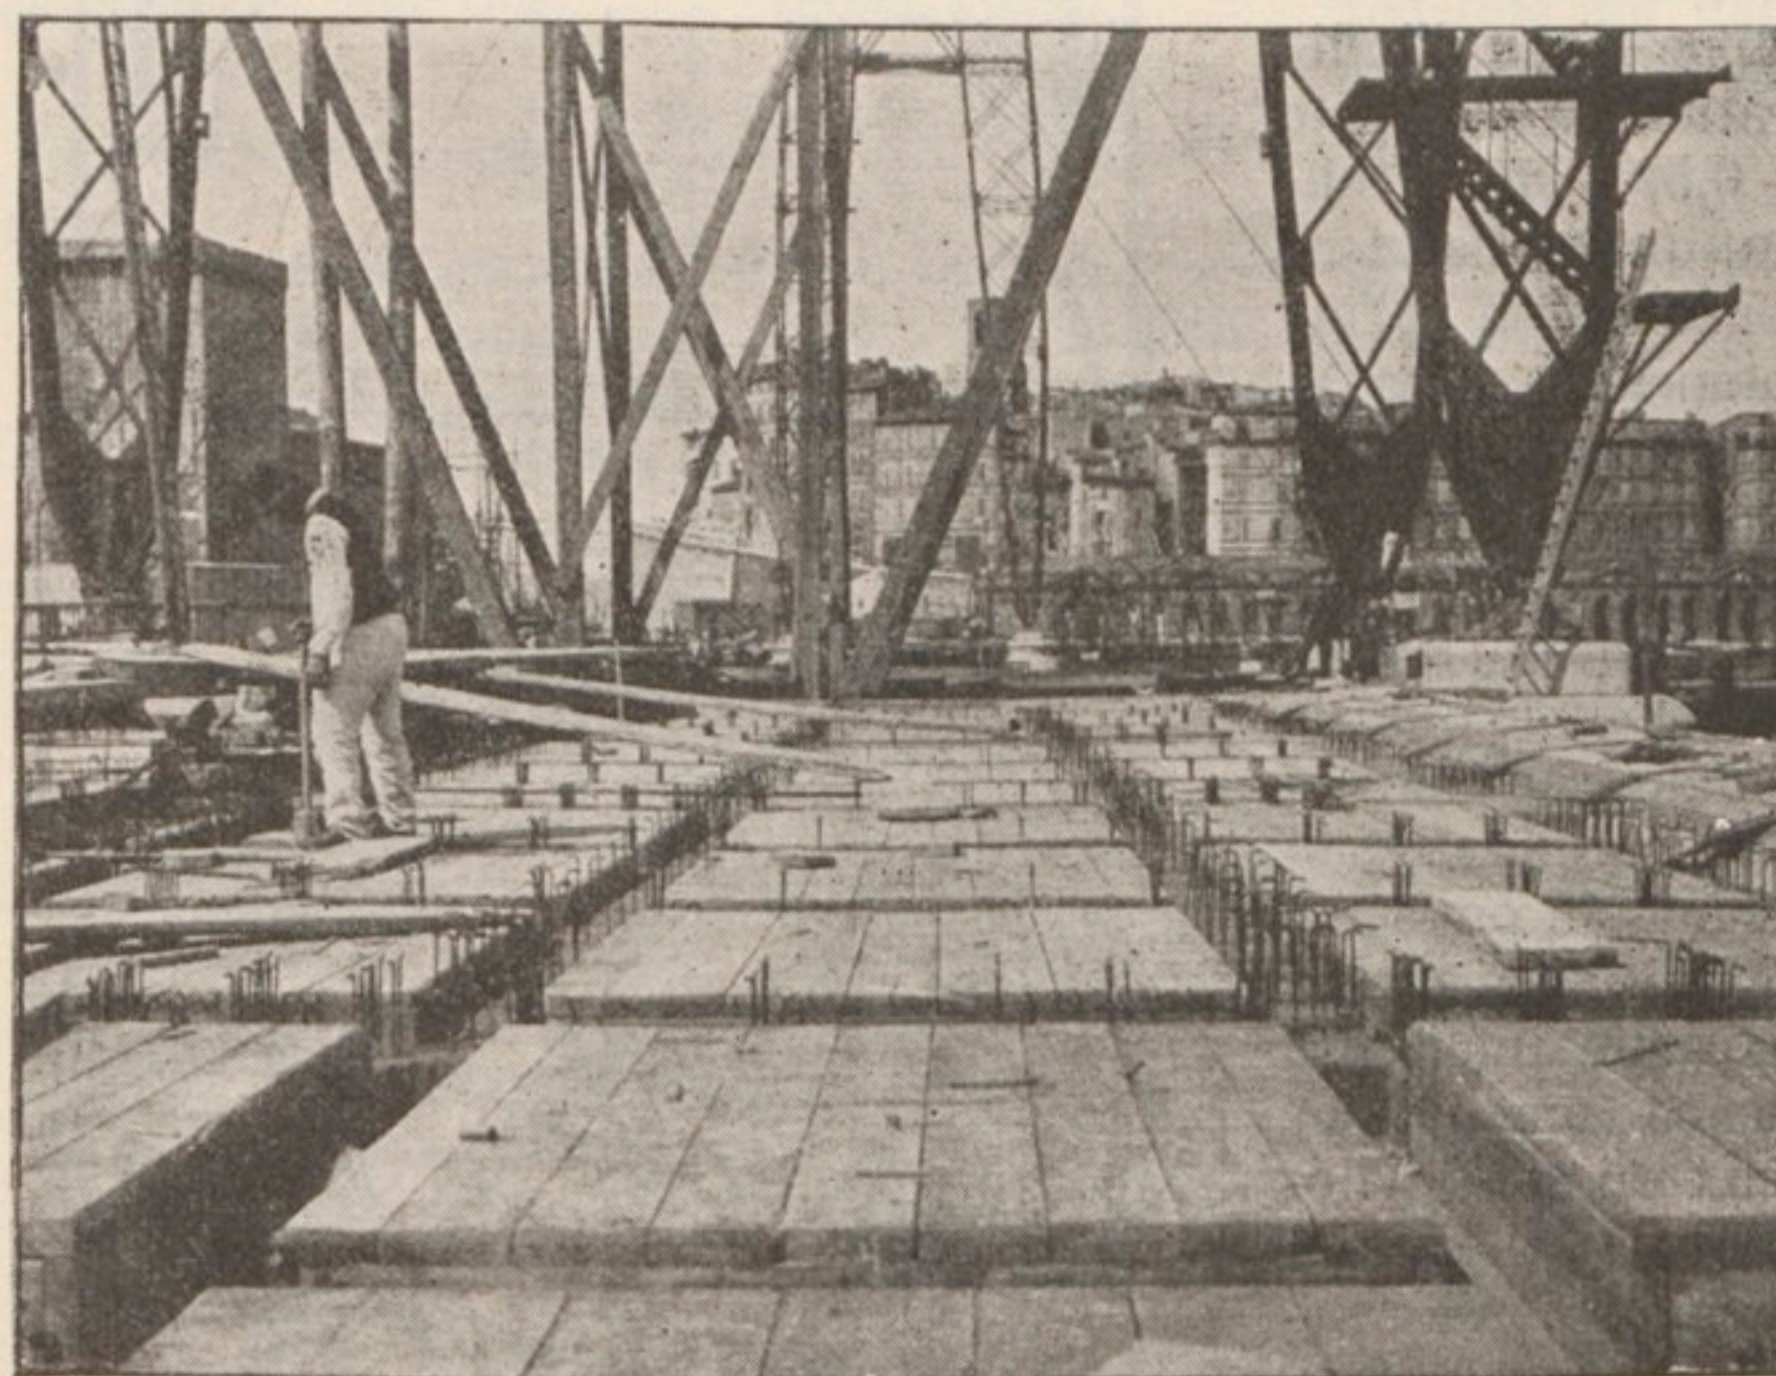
Construction de la chaussée d'accès en ciment armé.
